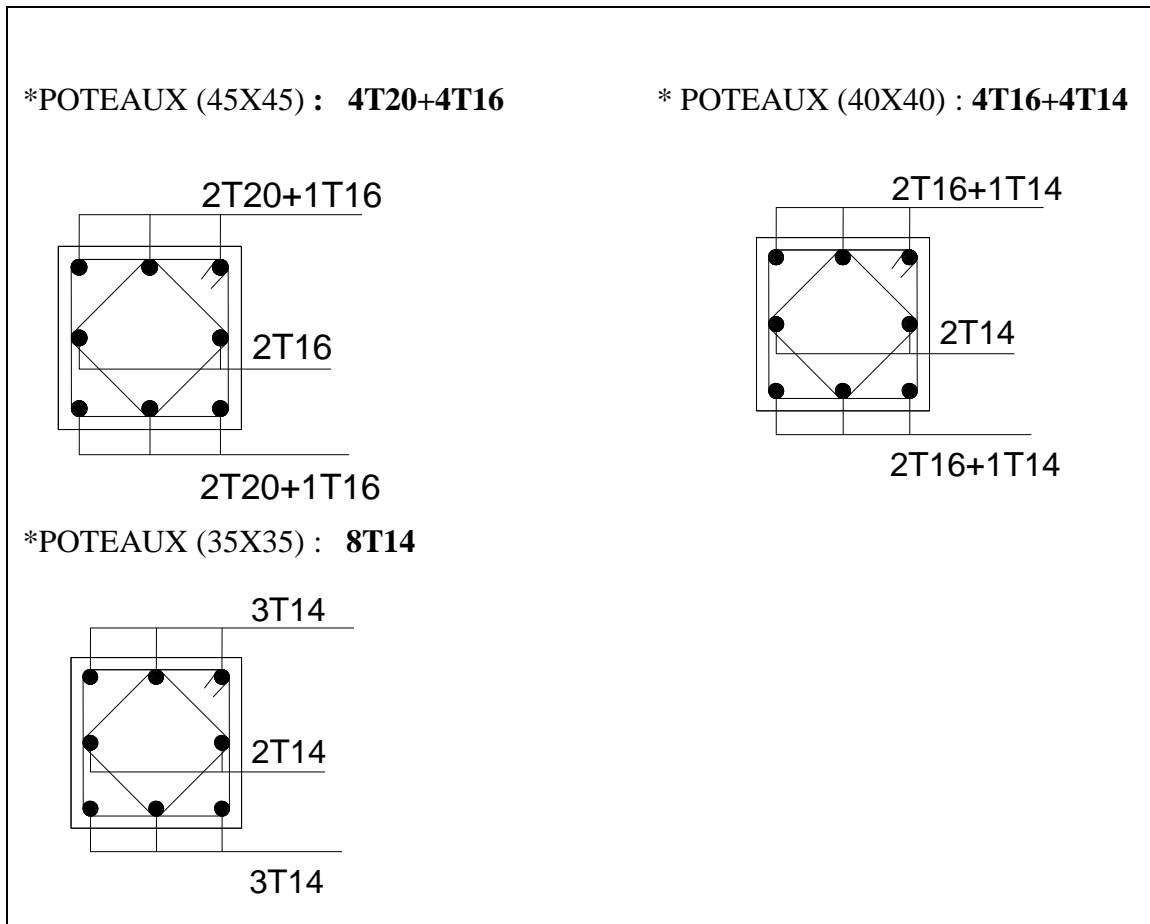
Dessin de ferrailages des sections des poteaux.
